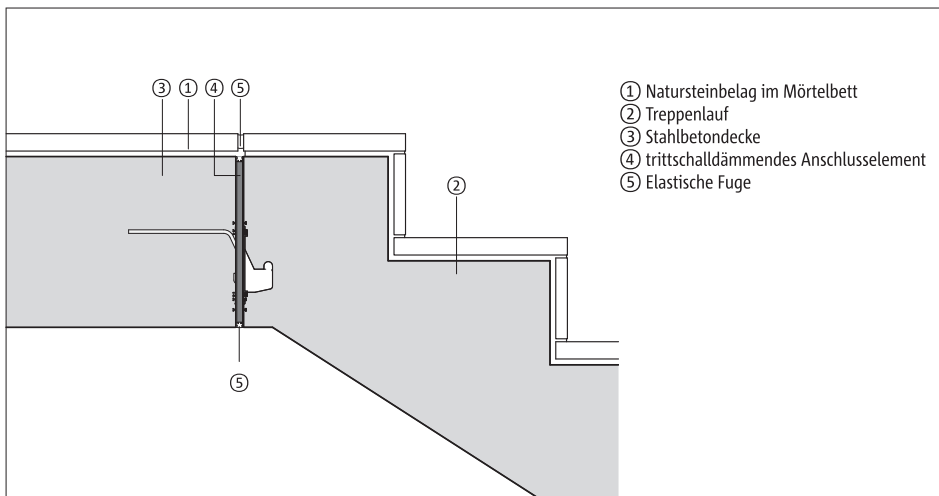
Beispielhaftes Anschlussdetail – Treppenlauf an Podest/Geschossdecke mit gerader Fuge
